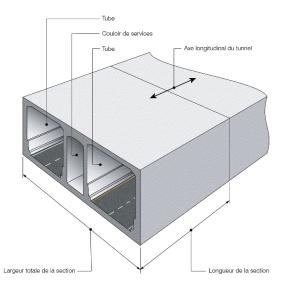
Largeur totale d'une section de tunnel constituée de plusieurs tubes
